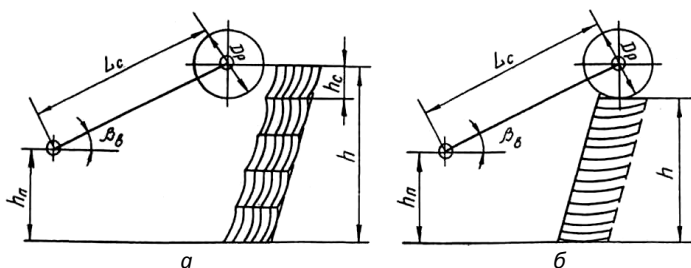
Схема к определению высоты уступа роторного экскаватора при выемке вертикальными (а) и горизонтальными (б) стружками
